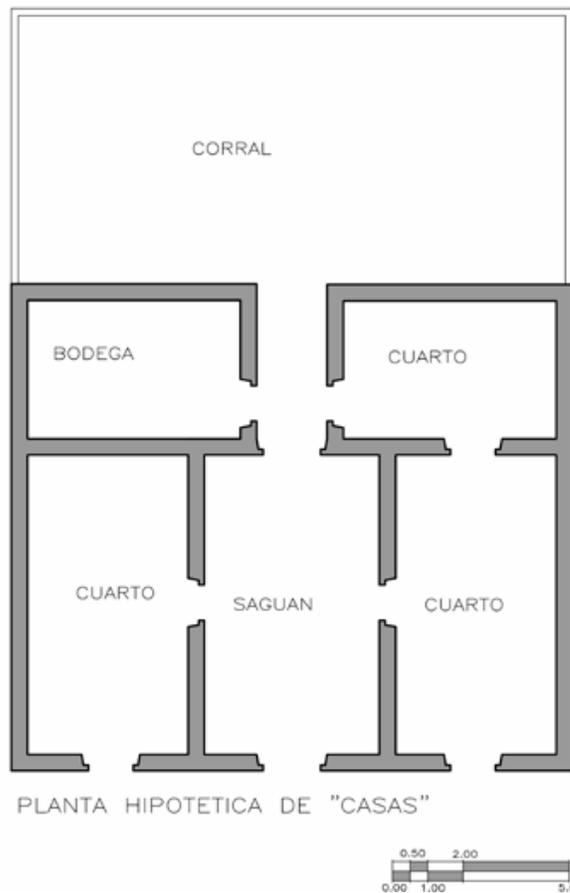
Planta Hipotética de “casas”, por X. Guevara, México, 2014
